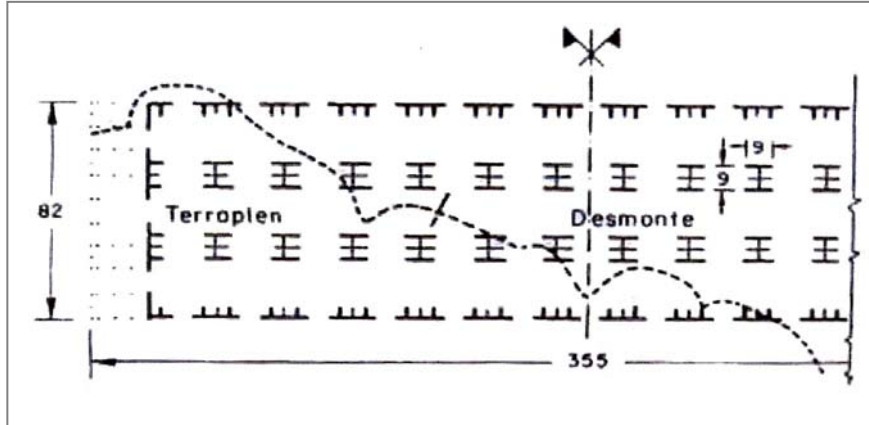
Planta de la Nave de Pescados de Mercamadrid.
